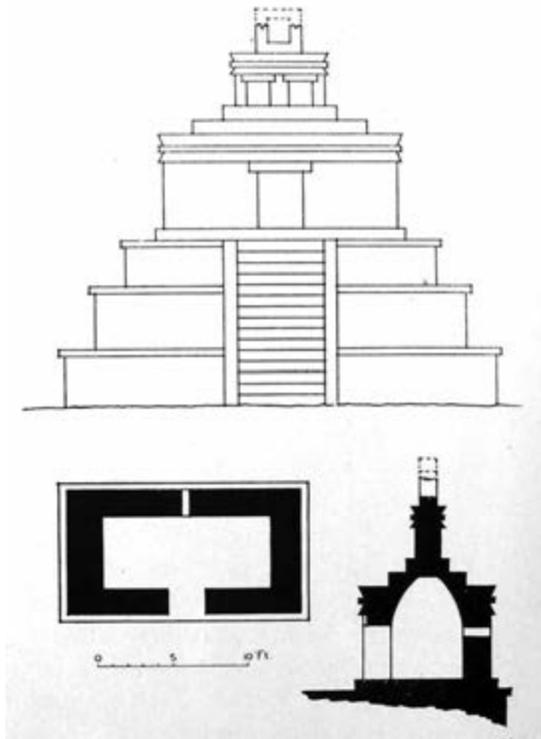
Levantamiento arquitectónico realizado por Samuel K. Lothrop quien registra en el corte y en el alzado de la fachada principal, los restos de la crestería que corona el templo de la Estructura 12, Tancah. Imagen: Lothrop, 1924.
